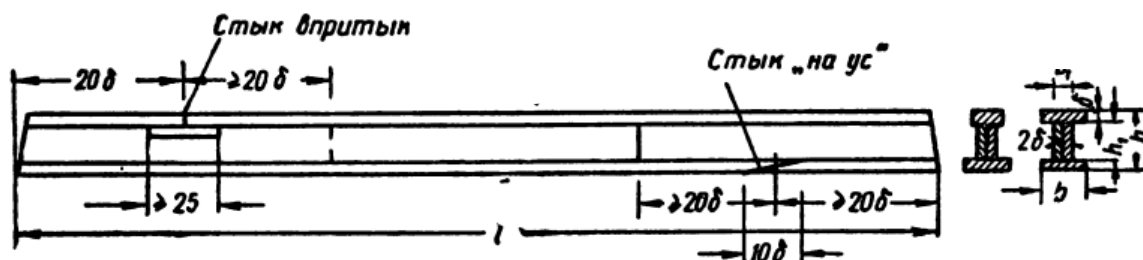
Клееные балки для перекрытий со стенкой из досок на ребро [2]
